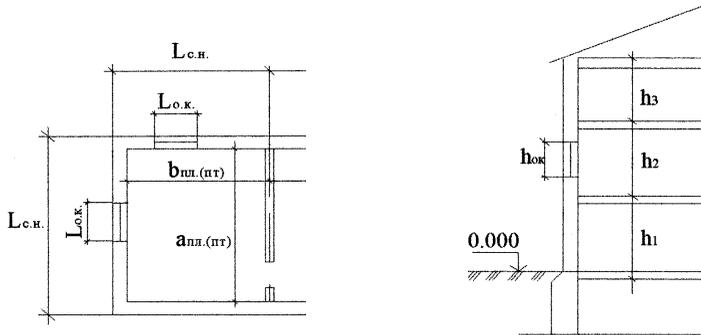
План помещения и разрез здания для расчета теплотерь
